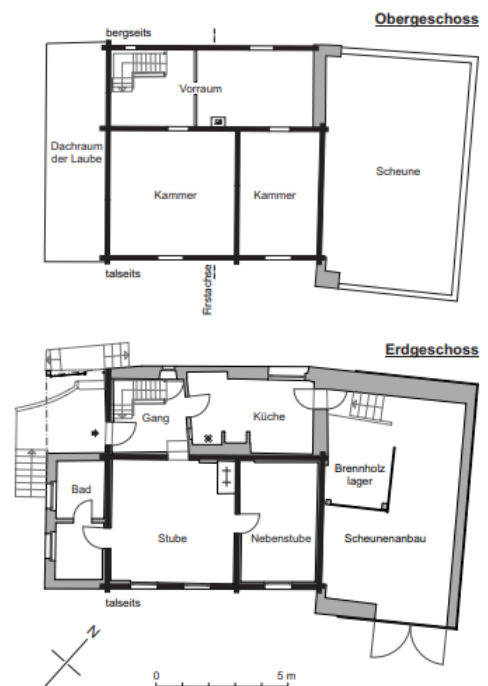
Grundrisse Erdgeschoss und Obergeschoss, 1:200.
